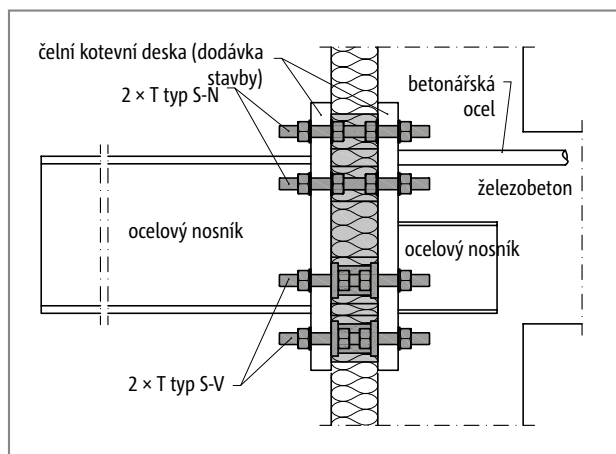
Schöck Isokorb® T typ S-N a T typ S-V: Volně vyložená ocelová konstrukce
